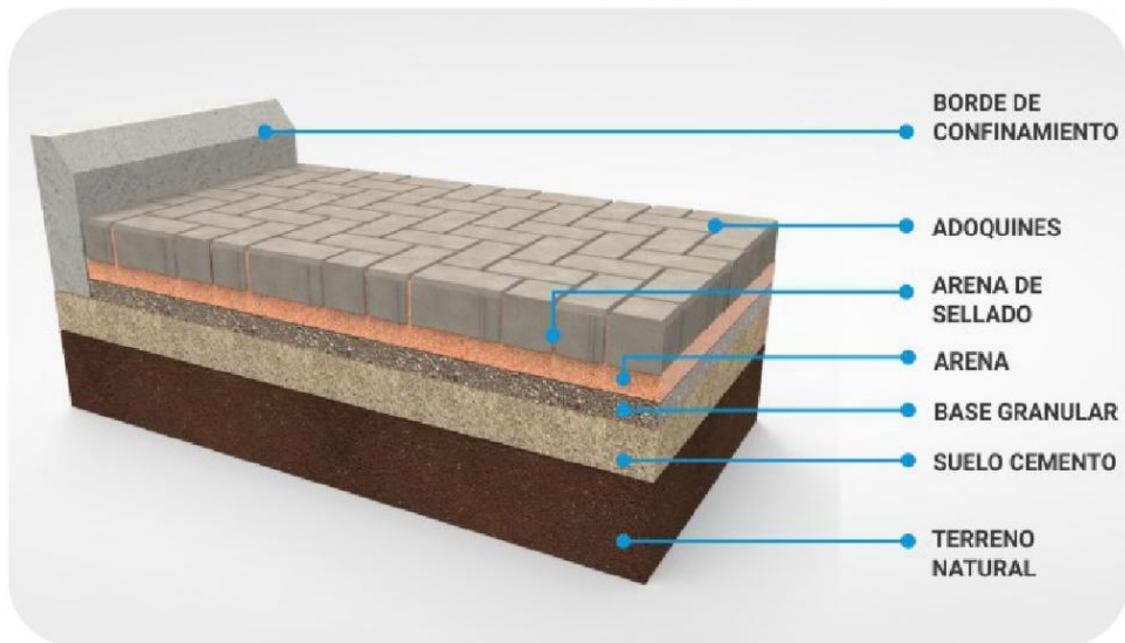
colocación de adoquines en vista cubica para evidenciar las capas
